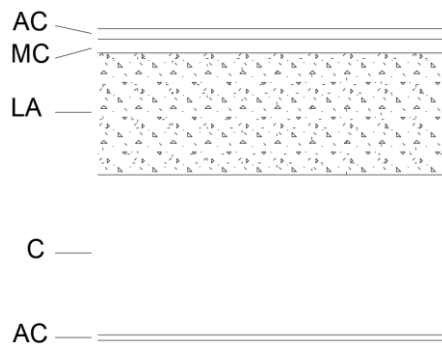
Esquema del sistema constructivo del forjado. Fuente: Elaboración propia
